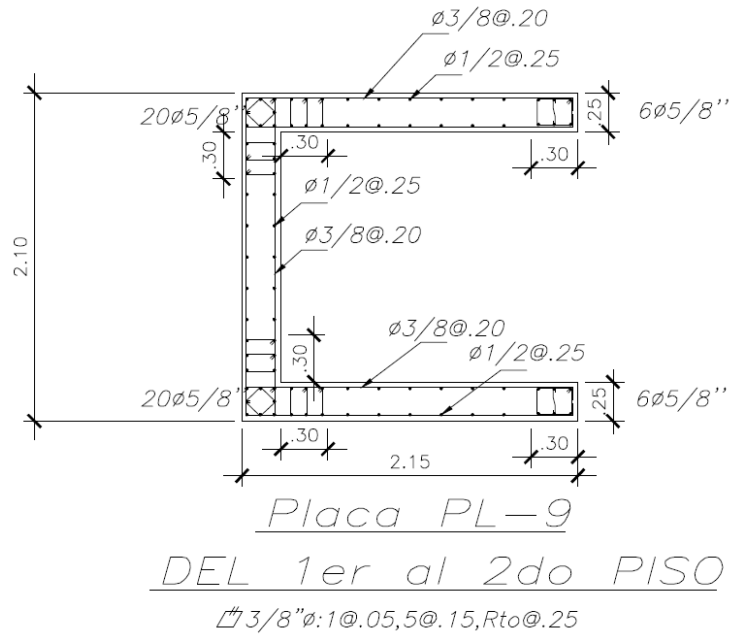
Distribución de acero y estribos de la placa PL-9.
